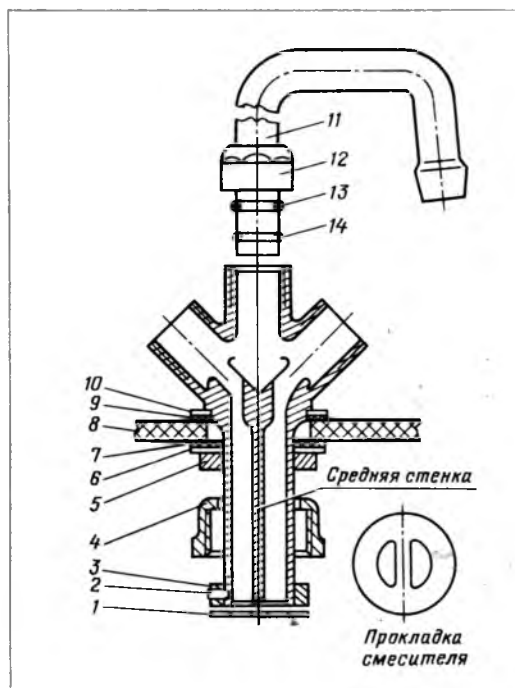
Смеситель «Елочка» с тройником: 1 — прокладка; 2 — стопор; 3 — гайка четырехгранная установочная; 4 — накидная гайка; 5 — поджимная гайка; 6, 10 — металлические шайбы; 7, 9 — резиновые прокладки; 8 — полочка мойки или умывальника; 11 — излив; 12 — накидная гайка; 13 — разжимное пластмассовое кольцо; 14 — резиновое кольцо
